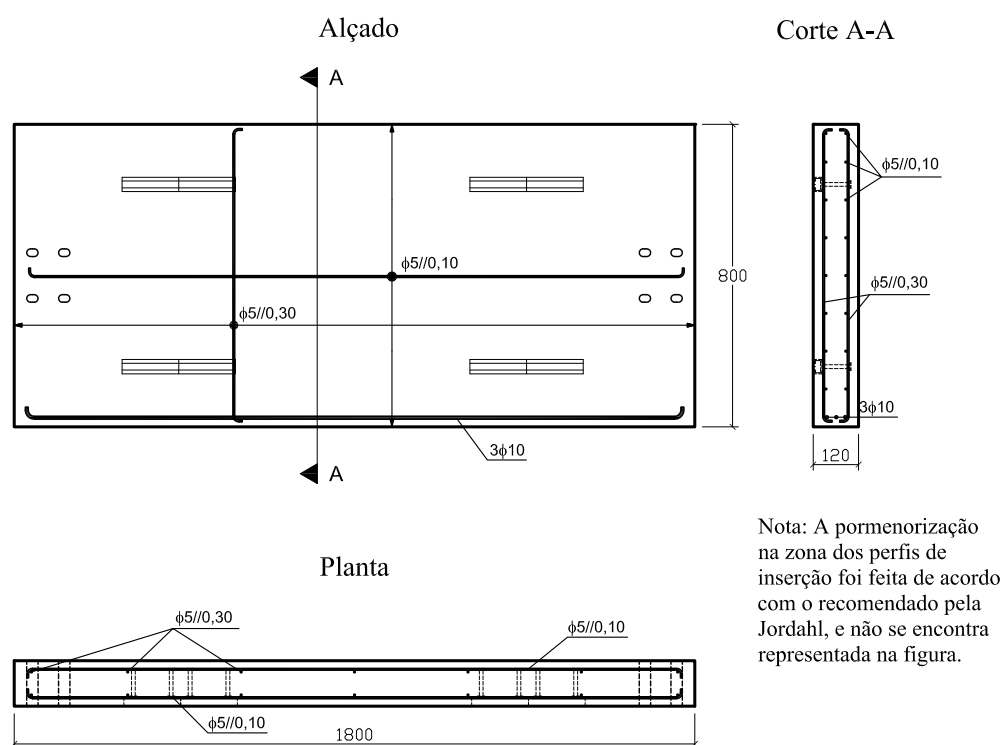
Pormenorização das armaduras dos painéis de fachada (mm)
